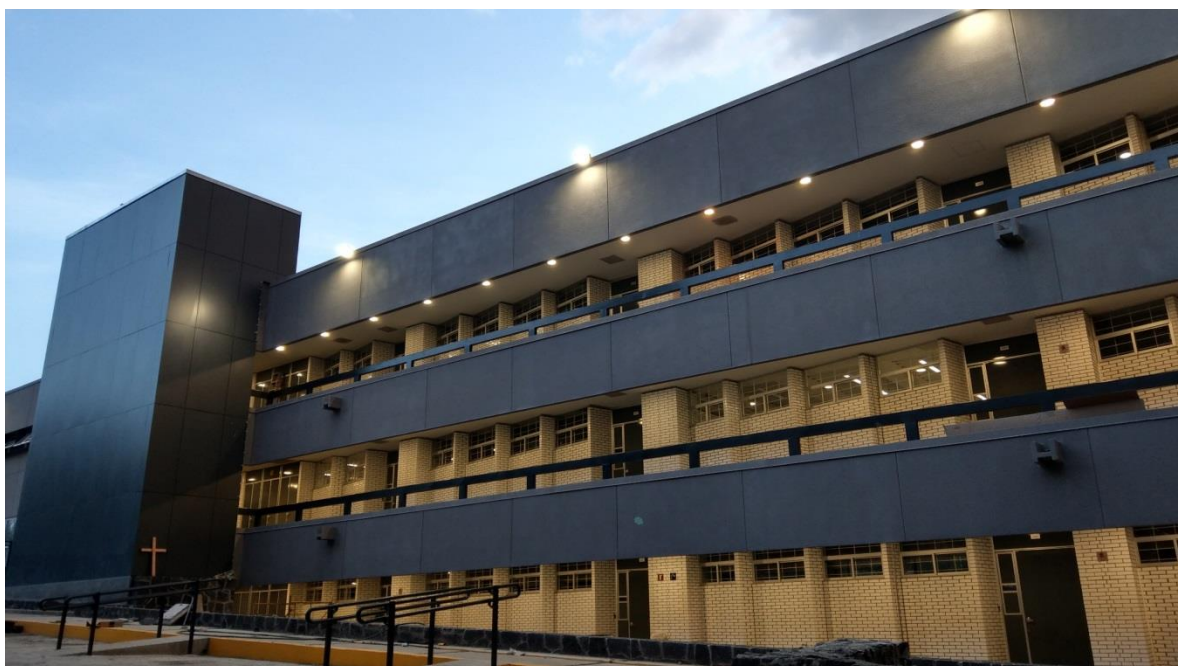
Fachada principal Edificio Y, archivo DGOC
